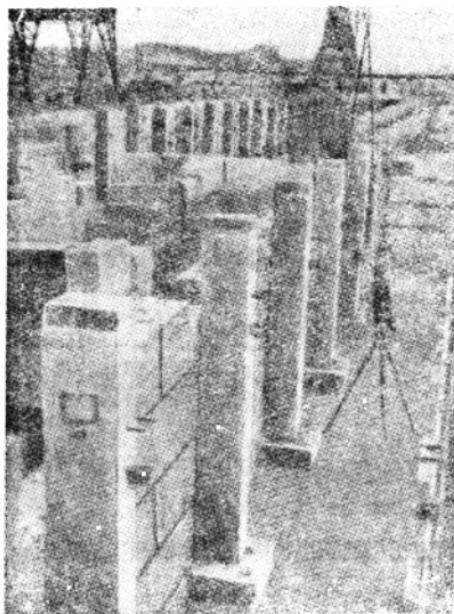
装配式钢筋混凝土柱和由混凝土砌块组成的地下室牆砌体
